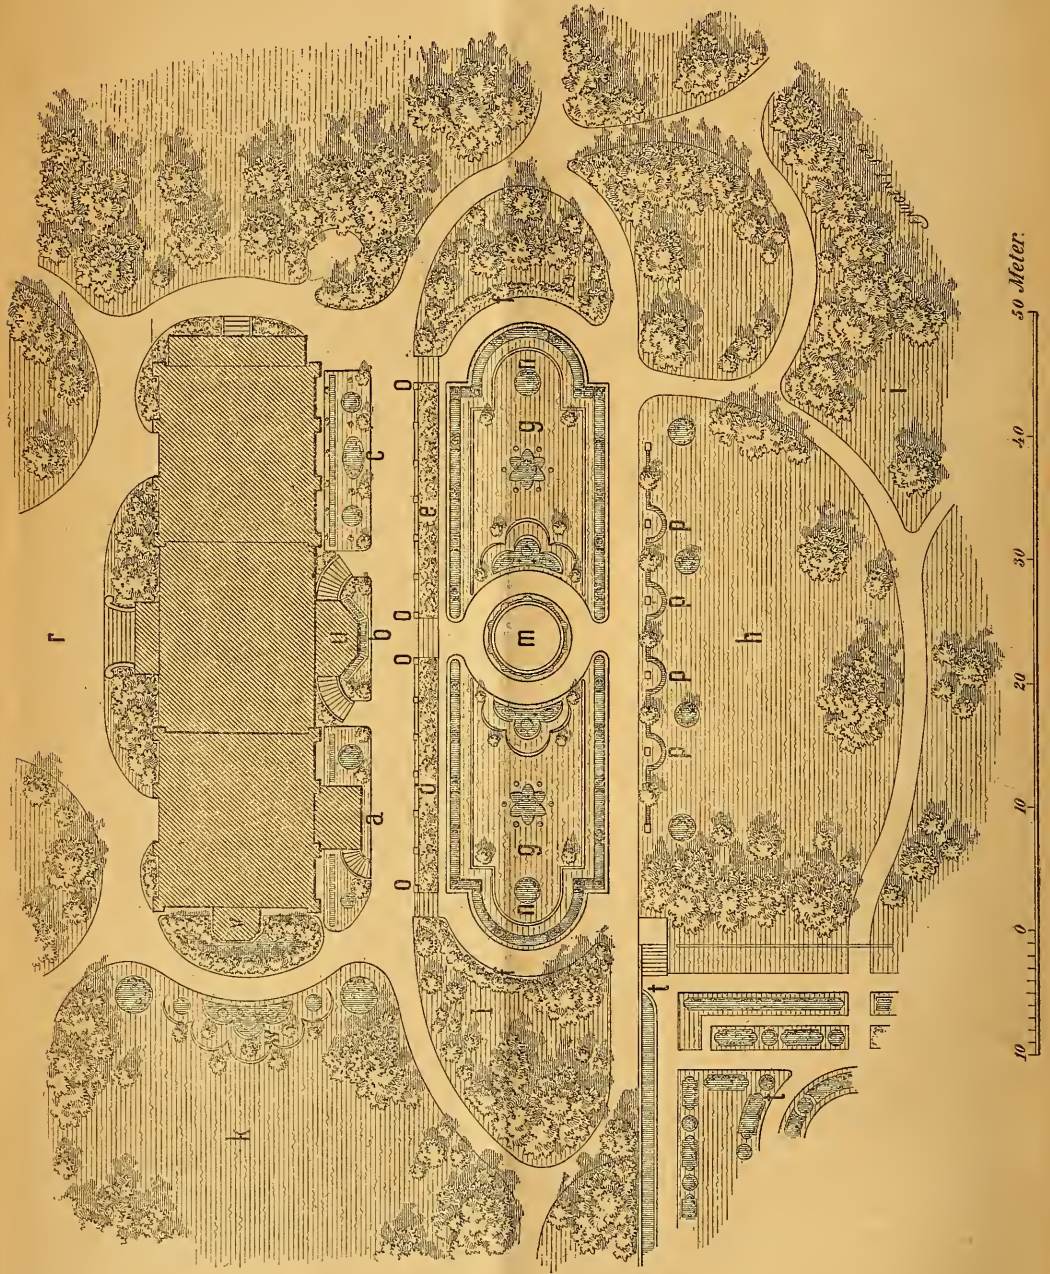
Schloss Monrepos. Grundriss.
